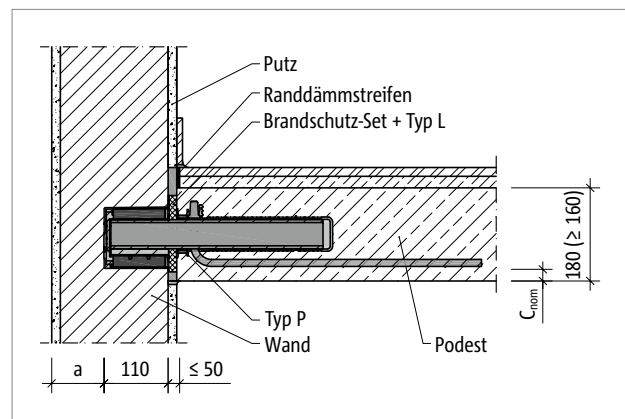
Schöck Tronsole® Typ P: Brandschutzausführung
